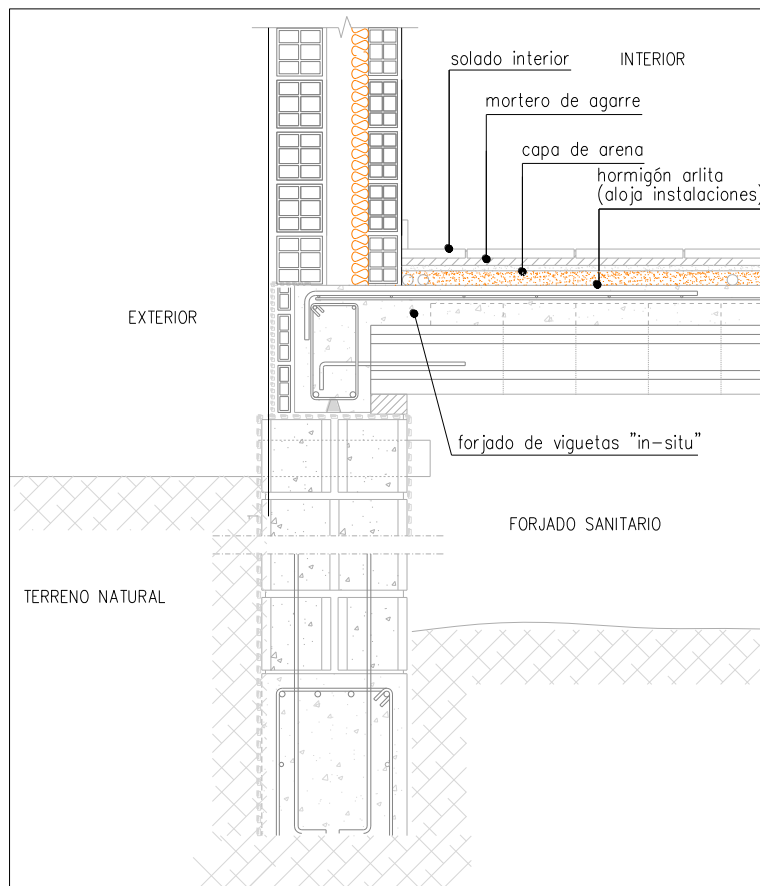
Detalle constructivo del suelo en contacto con cámara sanitaria
